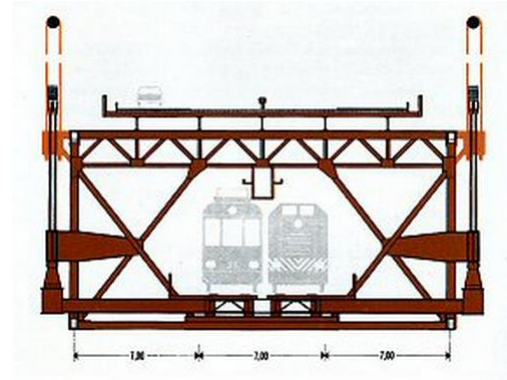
Secção transversal da viga de rigidez após o reforço estrutural (1999).[16]
